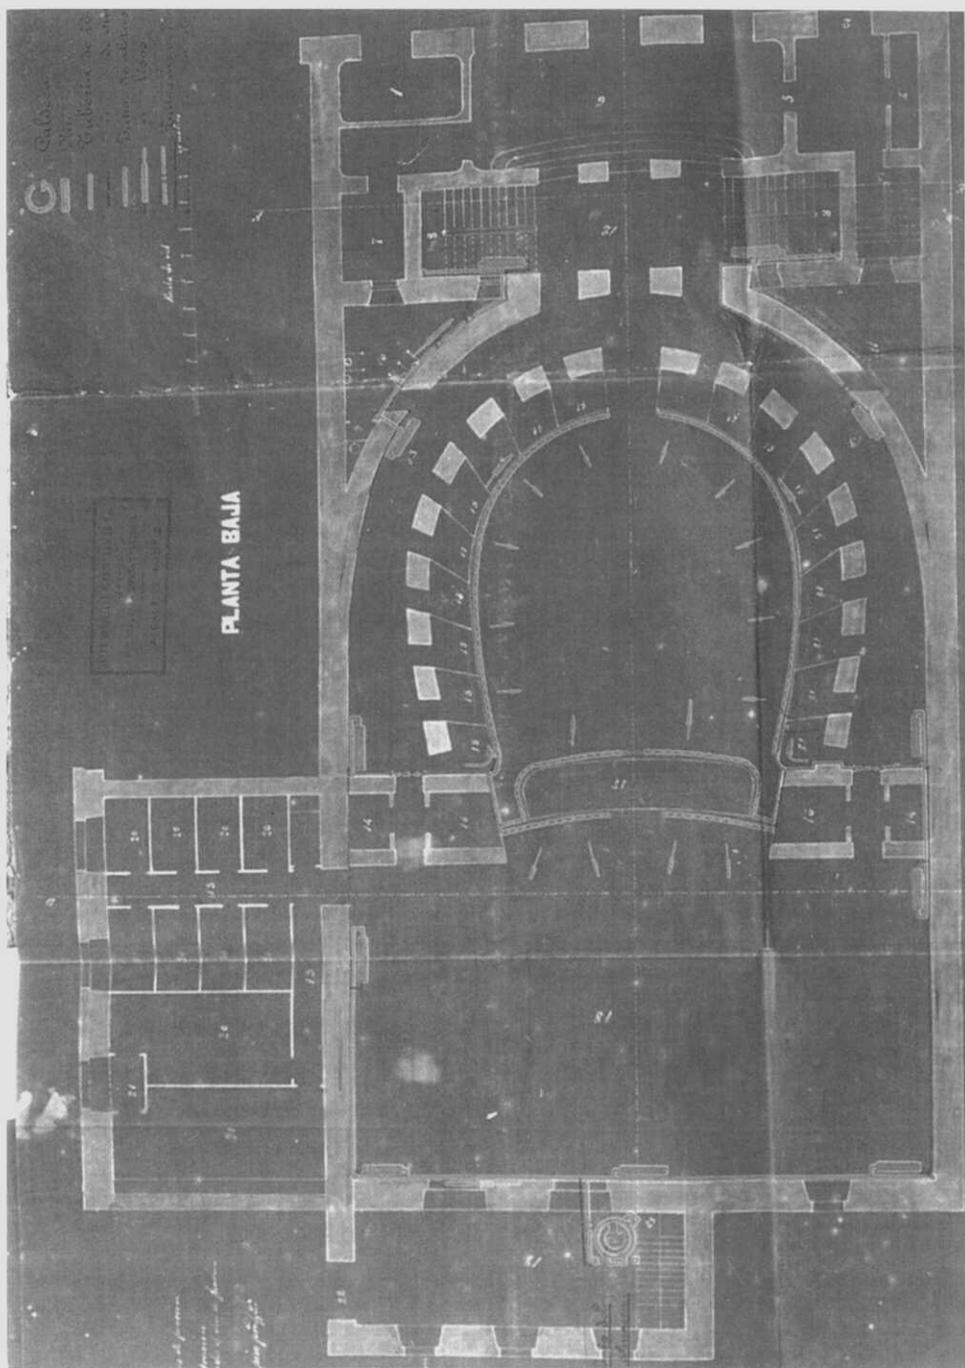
ASHCF Planta baja del Teatro en 1912.
